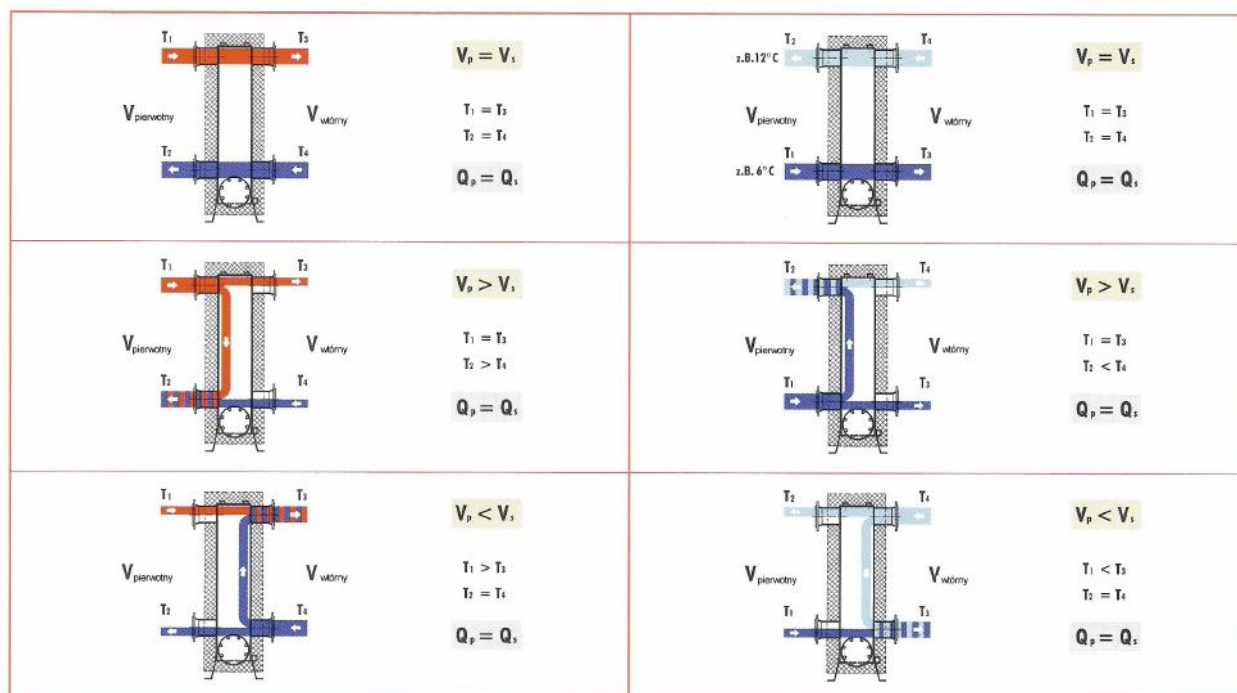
Układ instalacji grzewczej ze sprzęgłem hydraulicznym.
